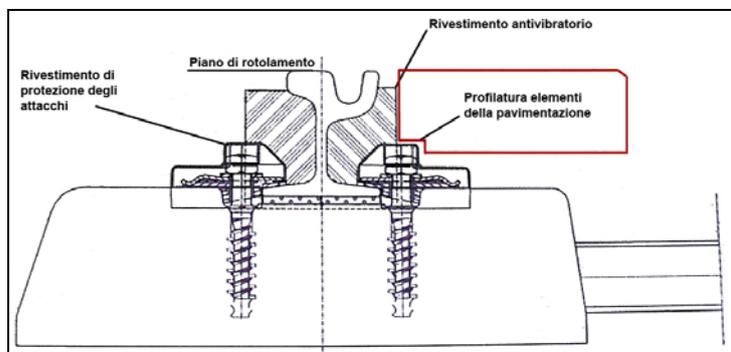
Schema di posa degli elementi adiacenti la rotaia [1]
